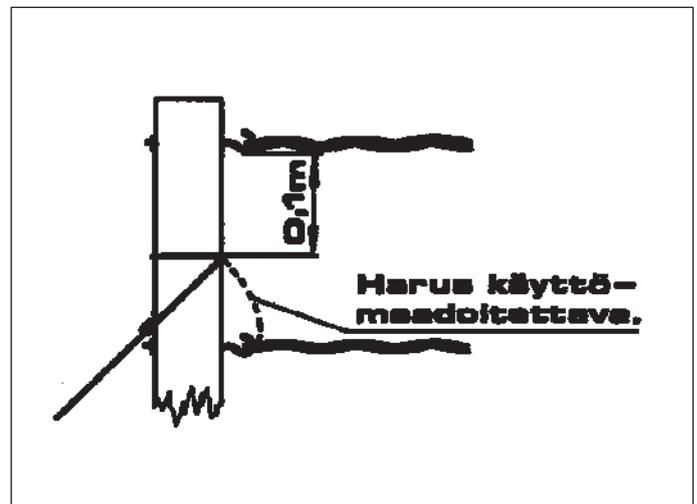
Монтаж оттяжки без соединения с проводом PEN.
